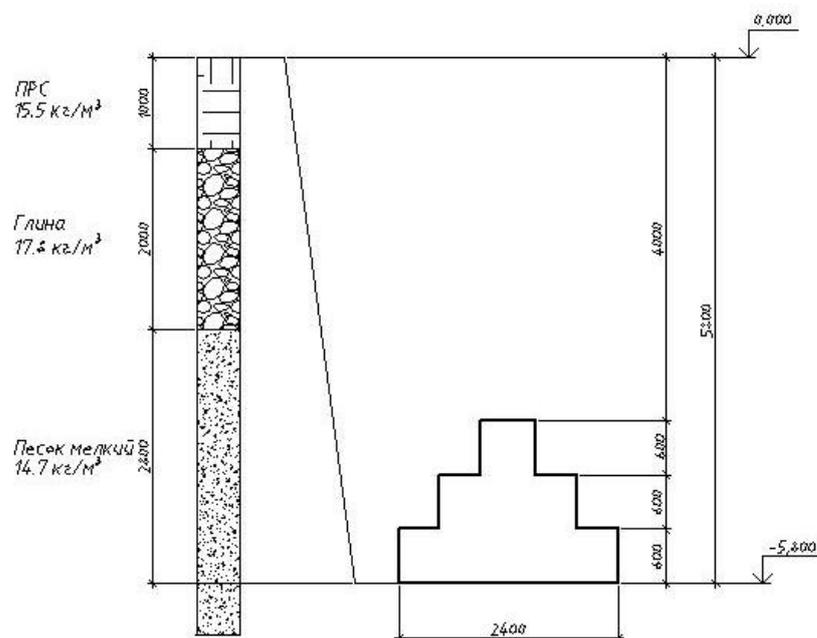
Расчетная схема фундамента под колонну в осях К/6
